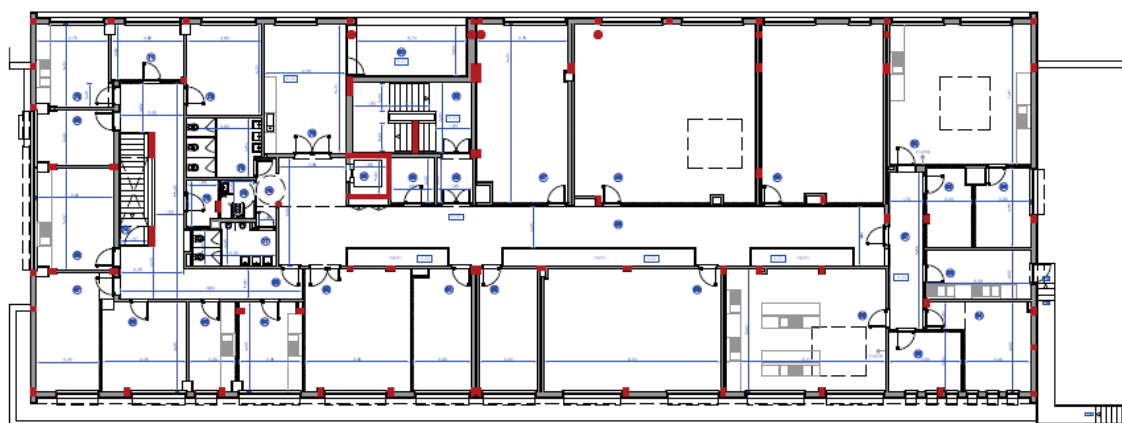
CeTeMares Planta Piso 2, sem escala, 10.03.2022, Instituto Politécnico de Leiria.
